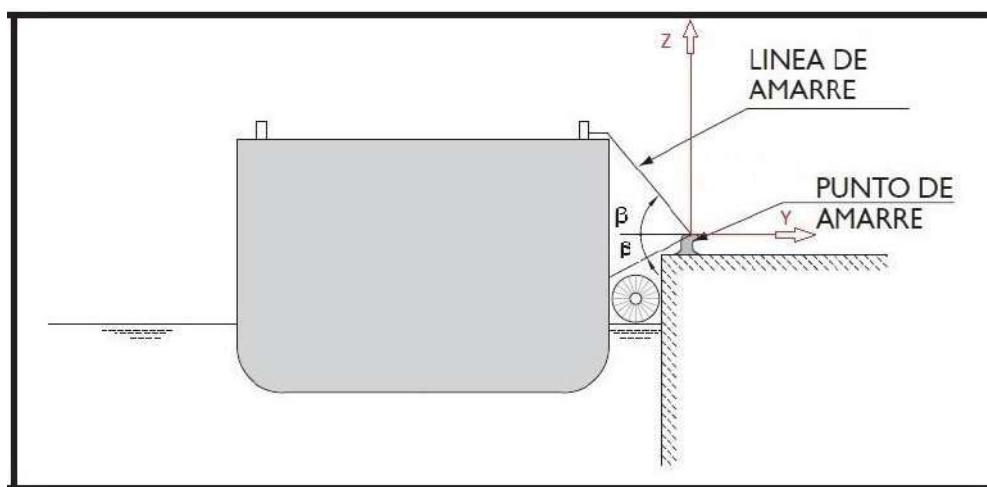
Disposición sugerida de ejes en el plano vertical.
